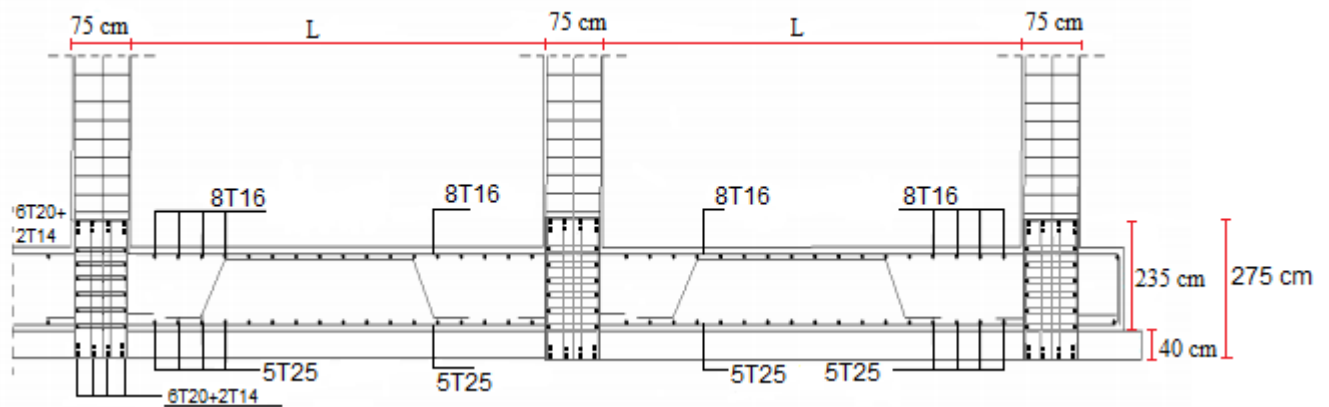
schéma de ferrailage de dalle de radier sens Y-Y.
